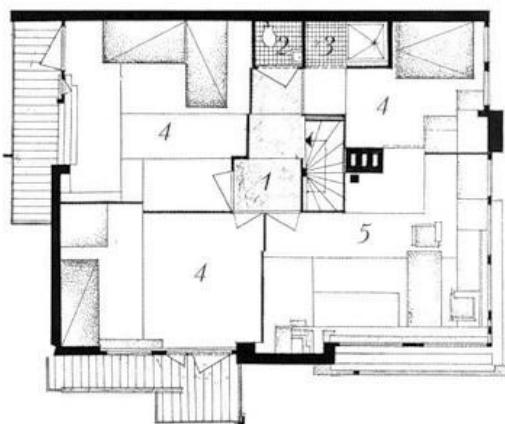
План 2-го поверху житлового будинку Трюссо Шредер, арх. Г. Рітвельд
